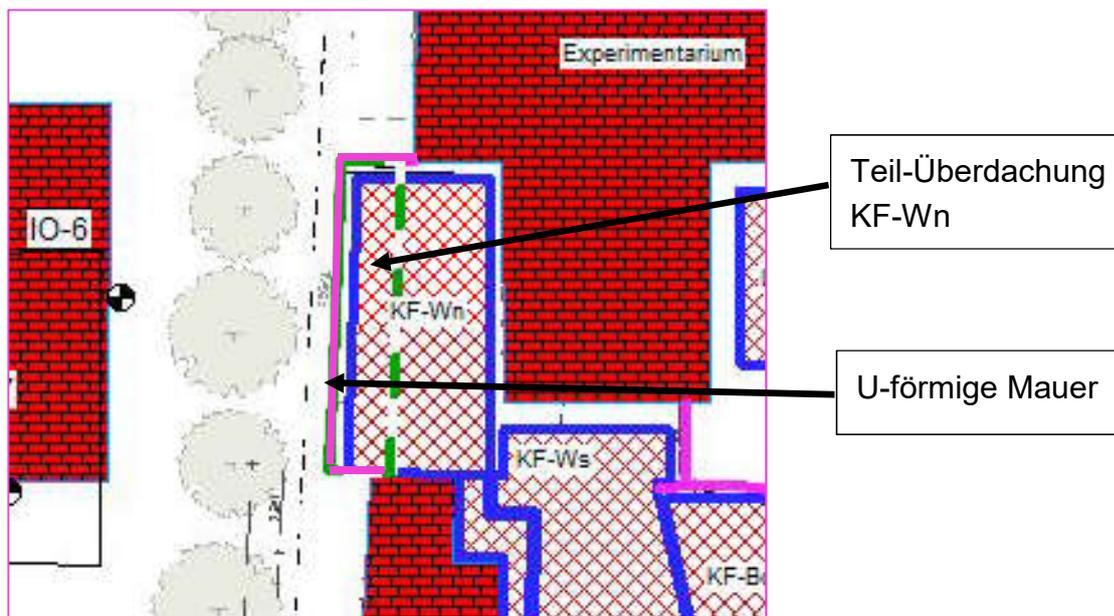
U-förmige Ummauerung mit Teilüberdachung im Rechenmodell
